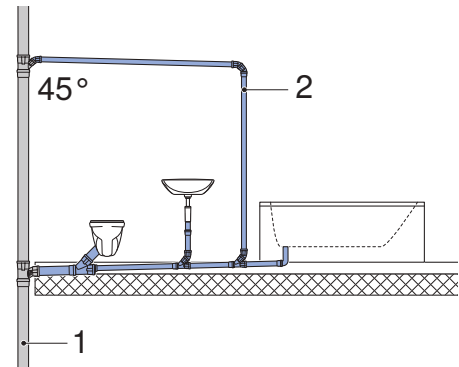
Malli, jossa kokoojahaaraviemärit lattiavalussa ja kytkentähaaraviemäri ja välipohjan alla
